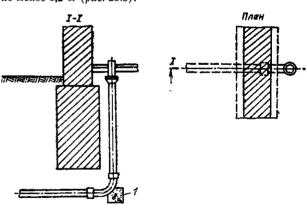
3. Ввод водопровода при ленточном фундаменте 1 — бетонный или кирпичный упор
